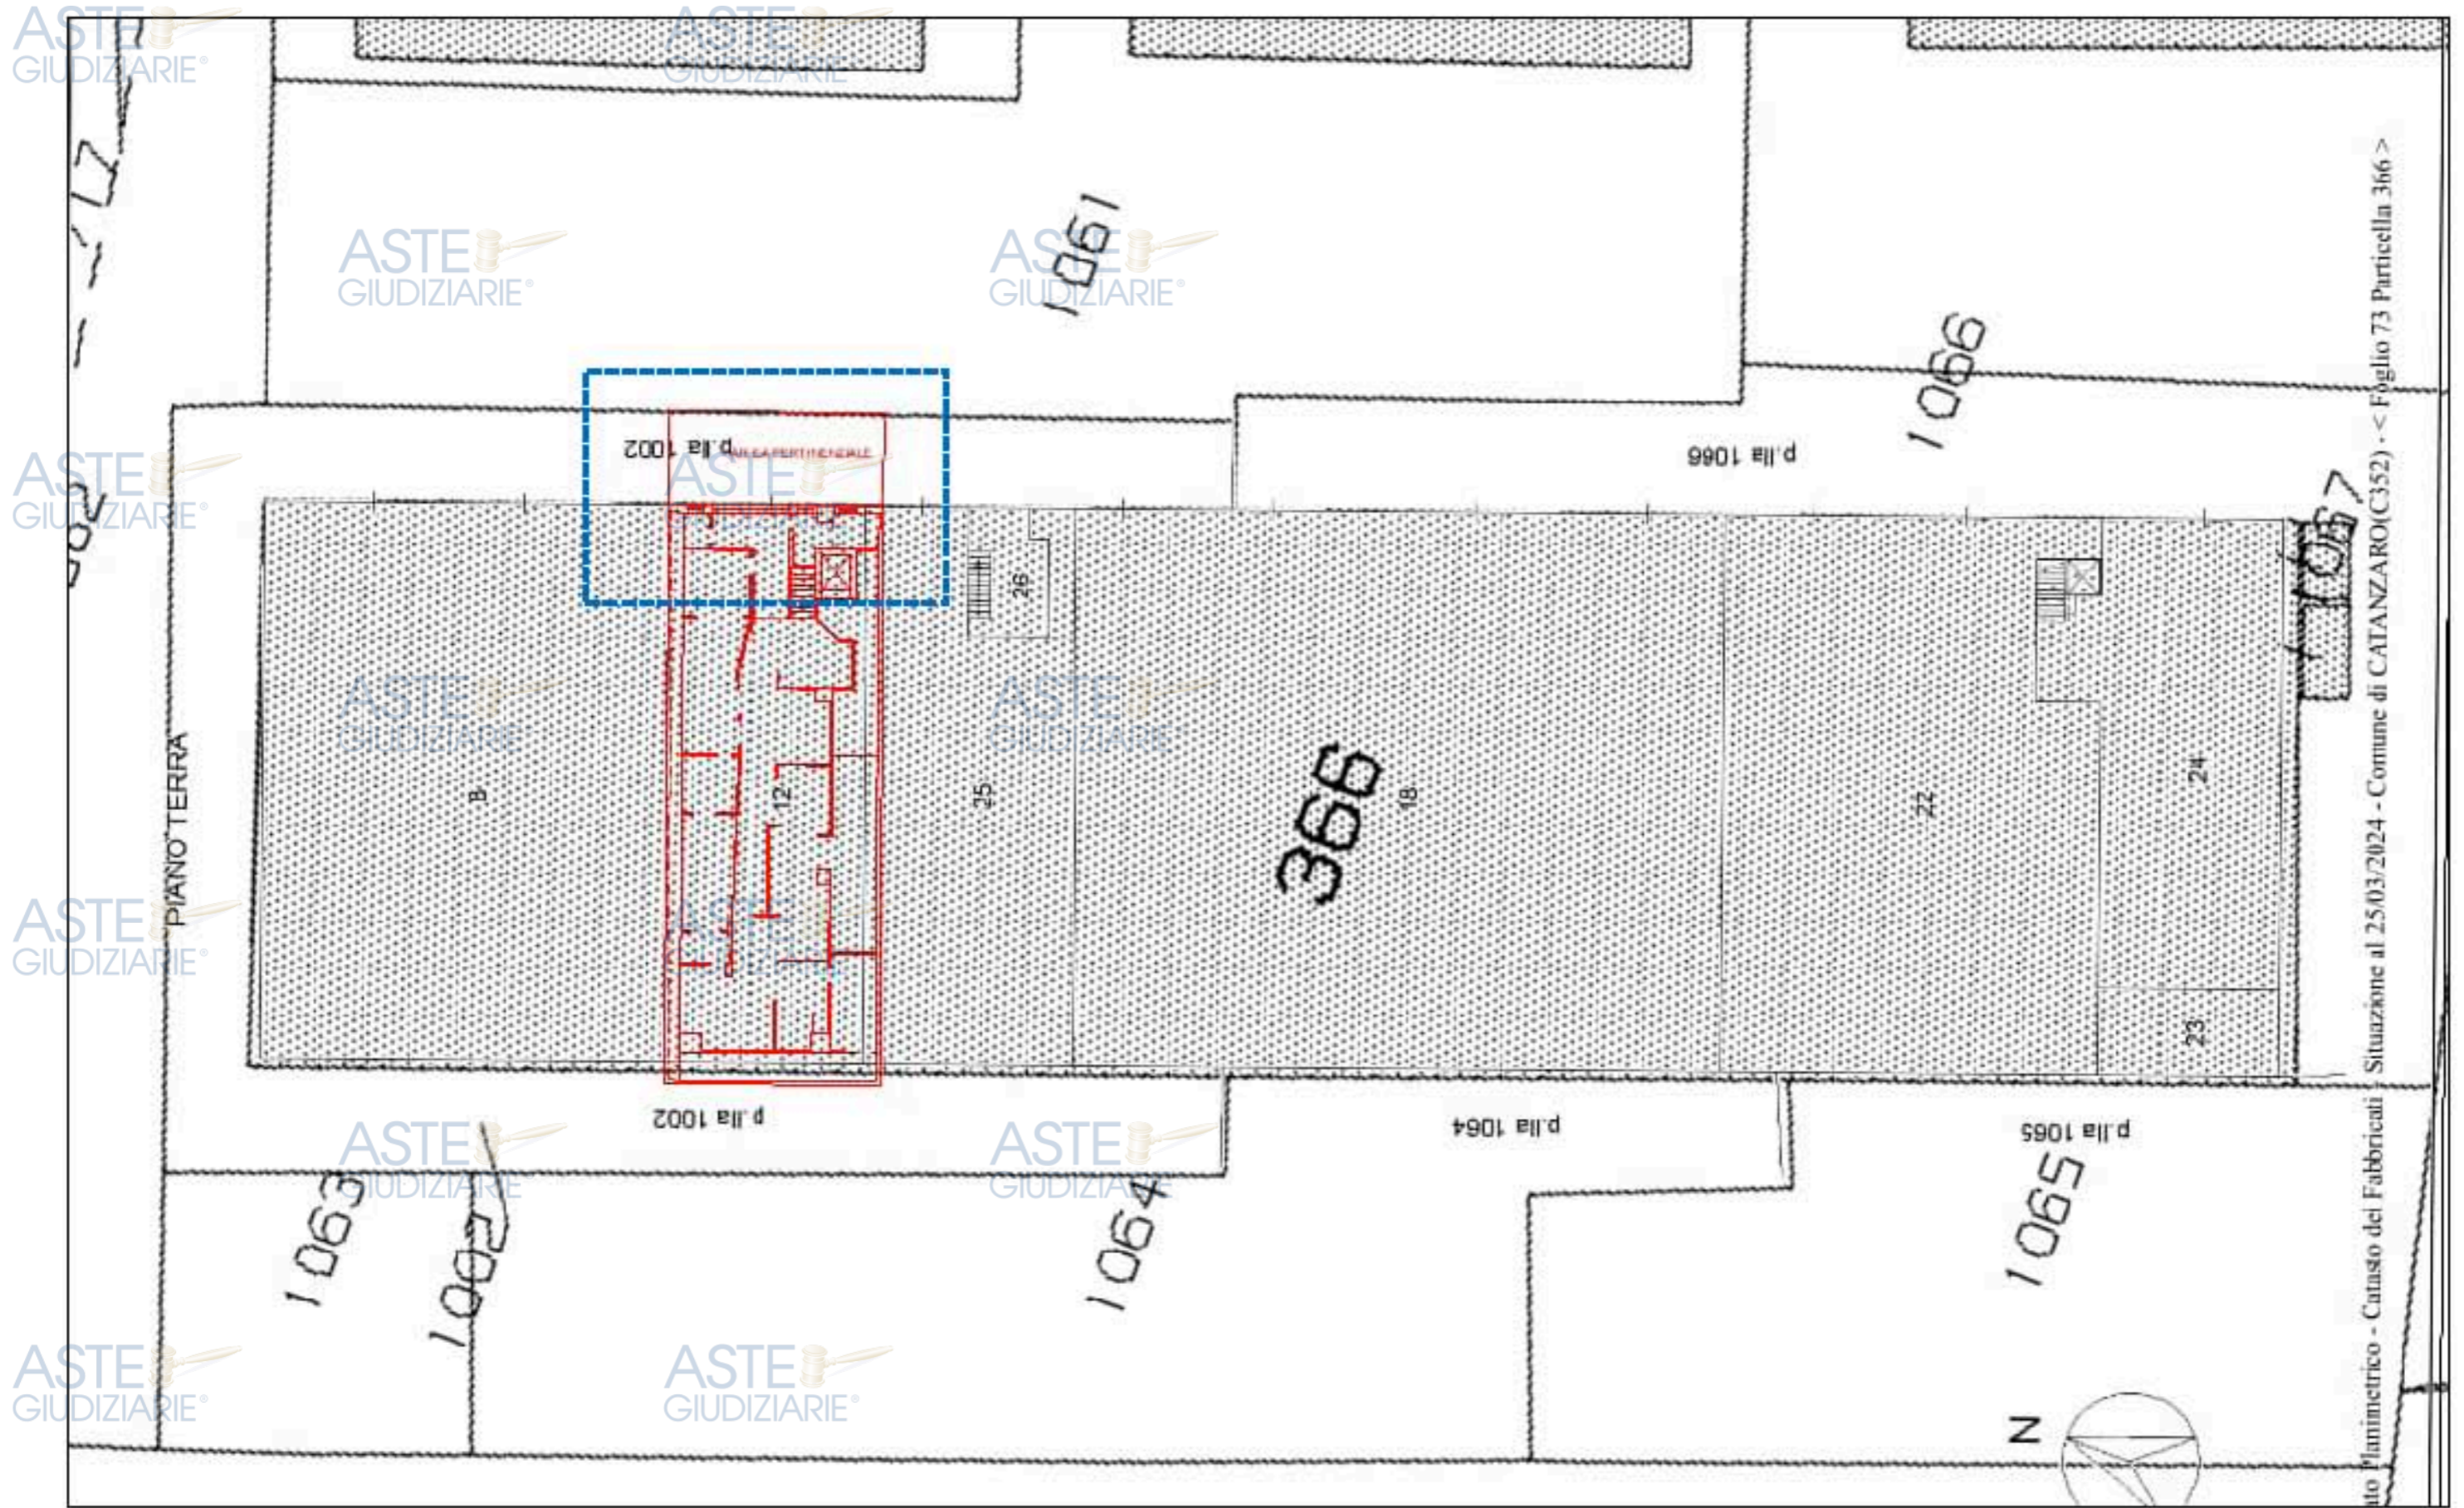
Sovrapposizione tra la planimetria da rilievo del subalterno 12, elaborato planimetrico della particella 366 ed estratto di mappa catastale del foglio 73 - Individuazione area pertinenza del subalterno 12
